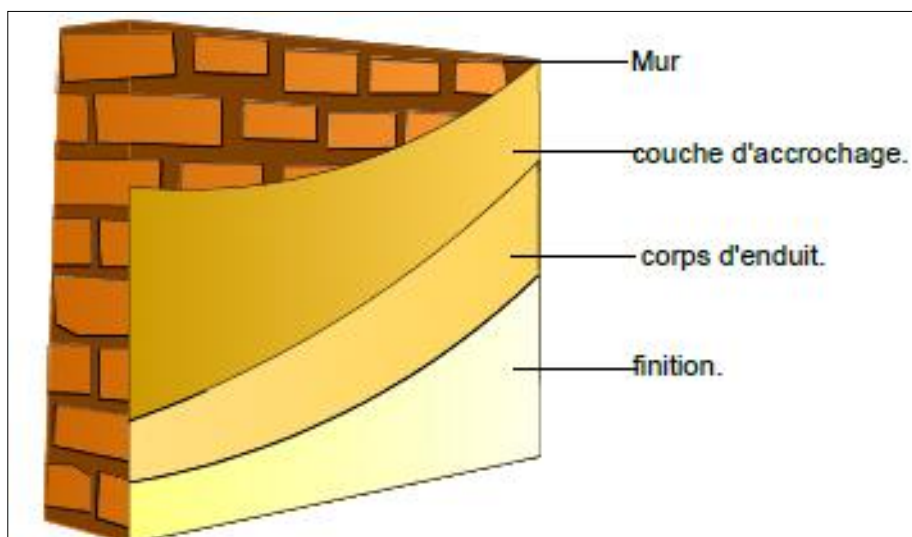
L'application de 3 couches du revêtement d'un mur Elaborer par l'étudiante
